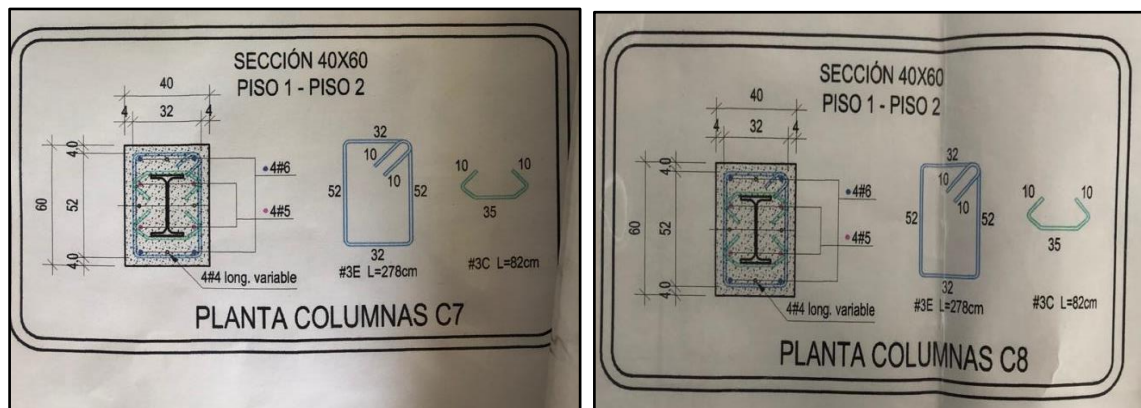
Columna tipo C7 y tipo C8. Fuente: tomada por el pasante.
